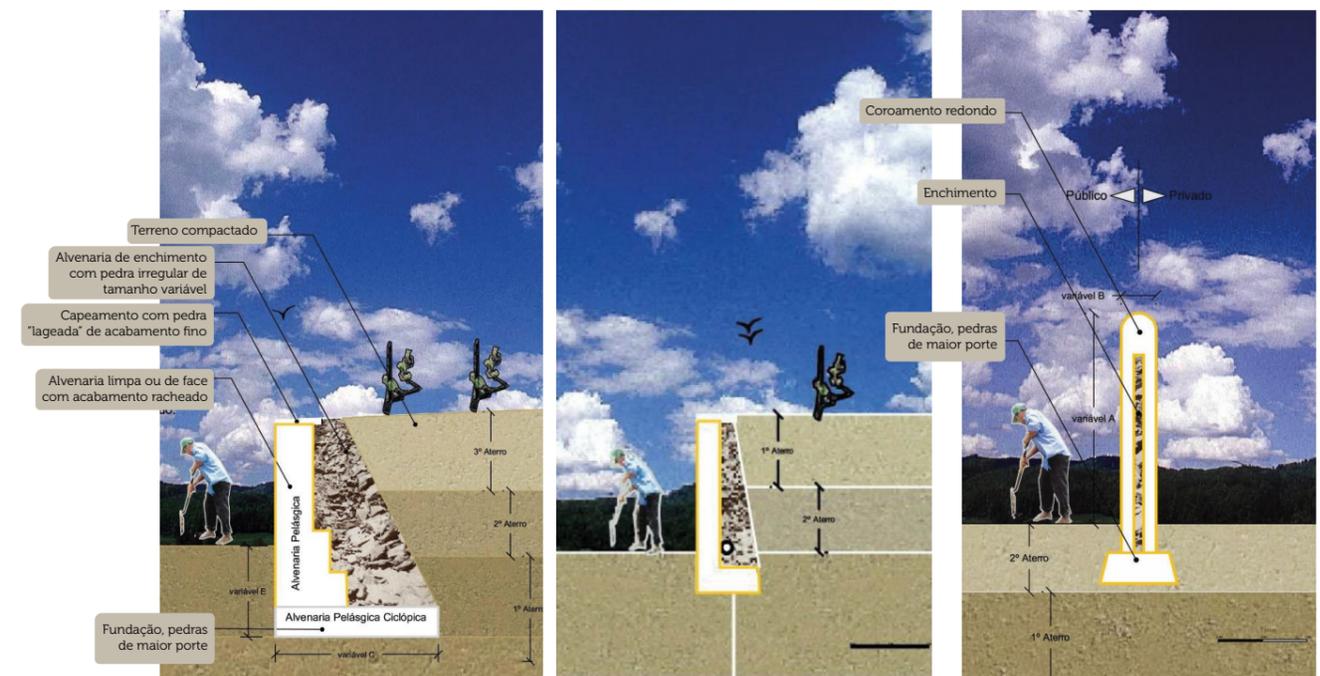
Ilustração da construção de muros de suporte e de divisão em pedra posta. (adaptado de Tojeiro 2005)
